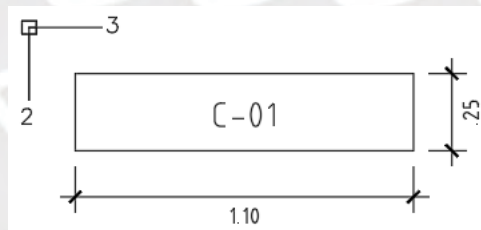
Sección transversal y orientación de ejes locales de la columna C/3 (C-01).
